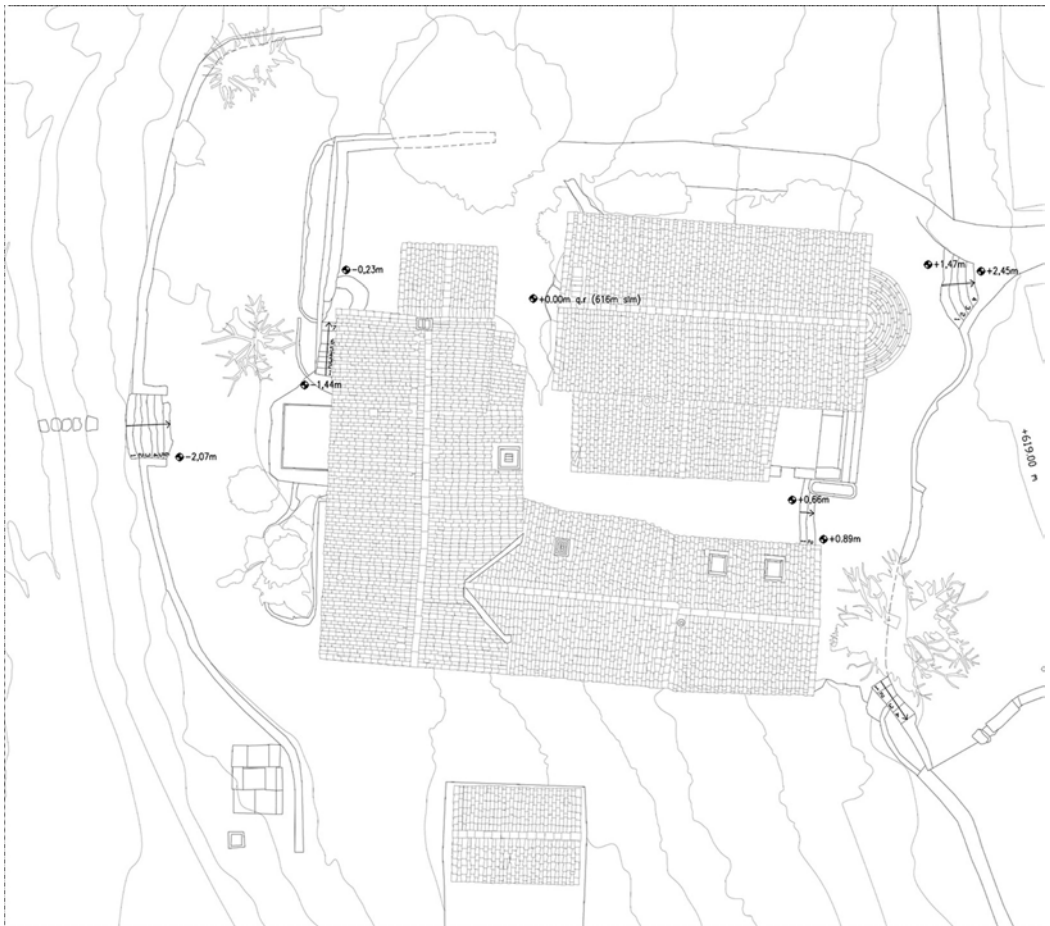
Planimetria del complesso di Santa Maria a Ferrano (elaborazione degli autori).
